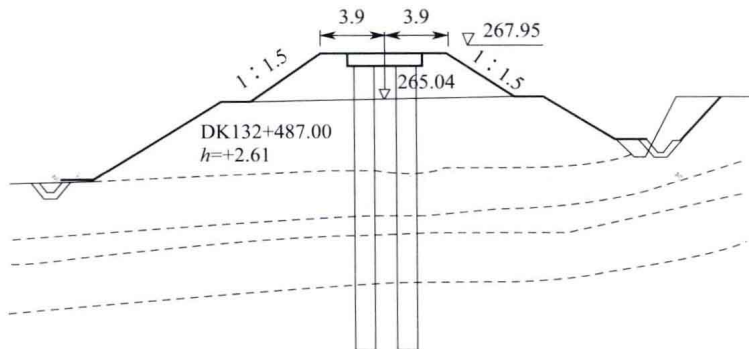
遂渝铁路 DK132 桩板结构路基典型横断面(m)
